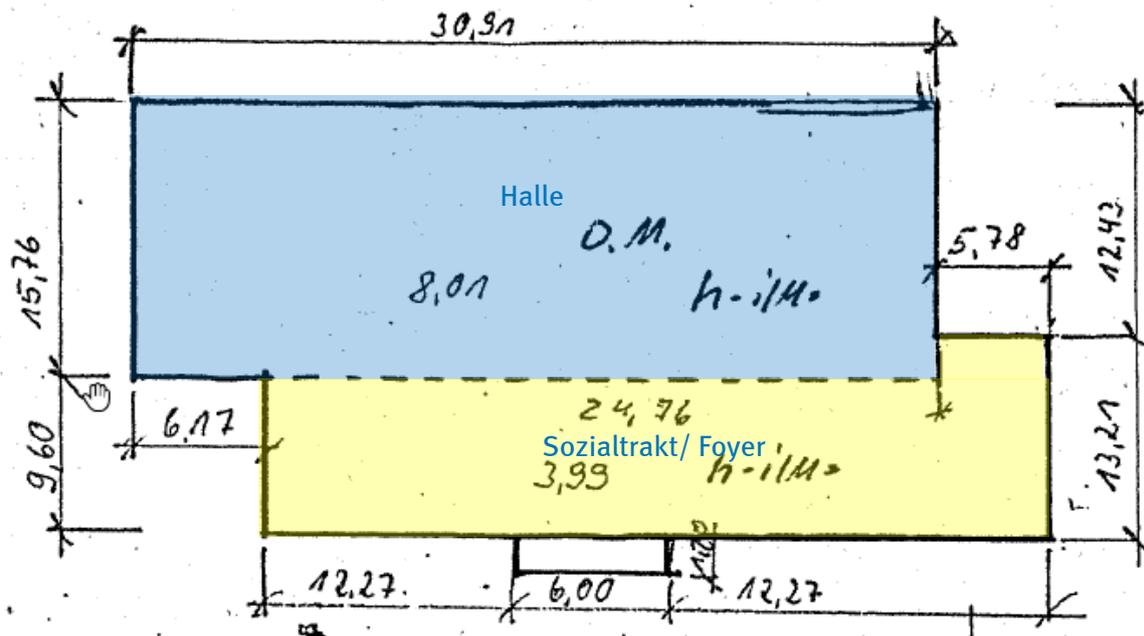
Skizze Grundriss TH 17 (Quelle: ZGM)
